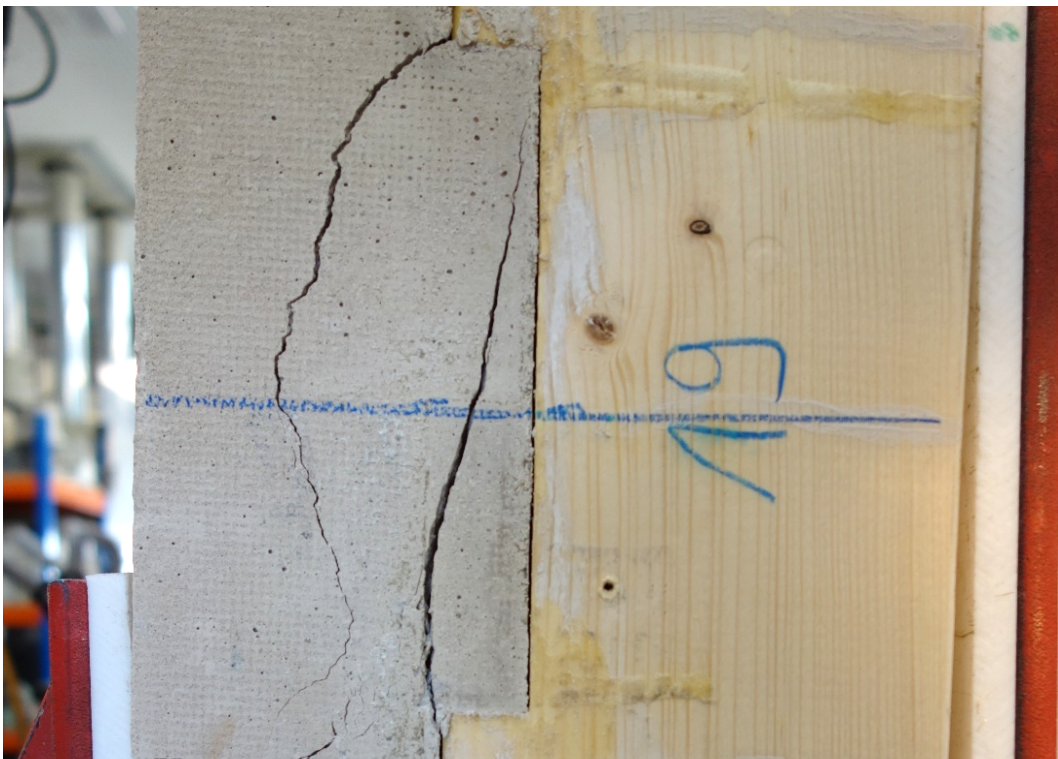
Beton-Schubrisse bei einem Scherprüfkörper mit CAF470
